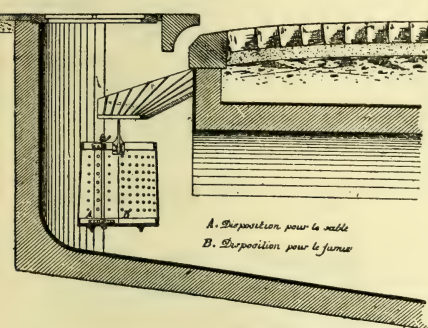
Bouche d'égout avec panier-filtre. (Imbeaux.)
